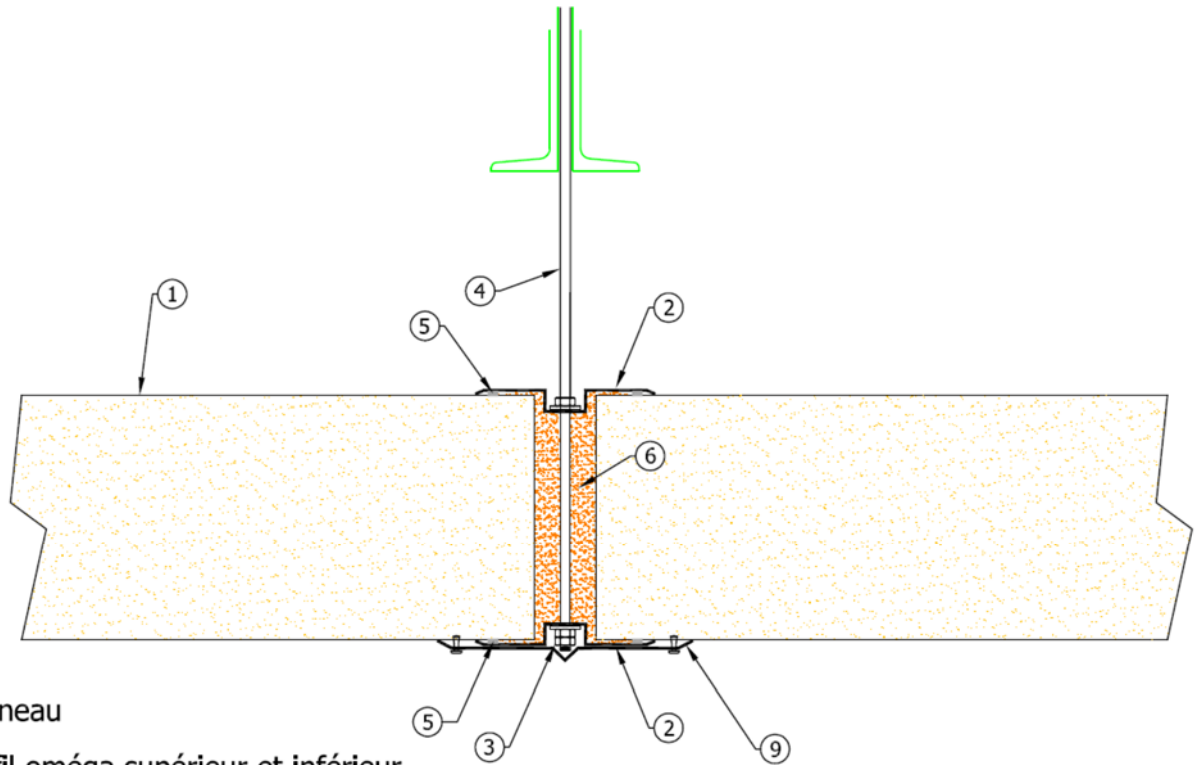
Fixation des panneaux de plafond par profil Oméga et entretoises PVC – – tiges filetées fixées au profil inférieur
